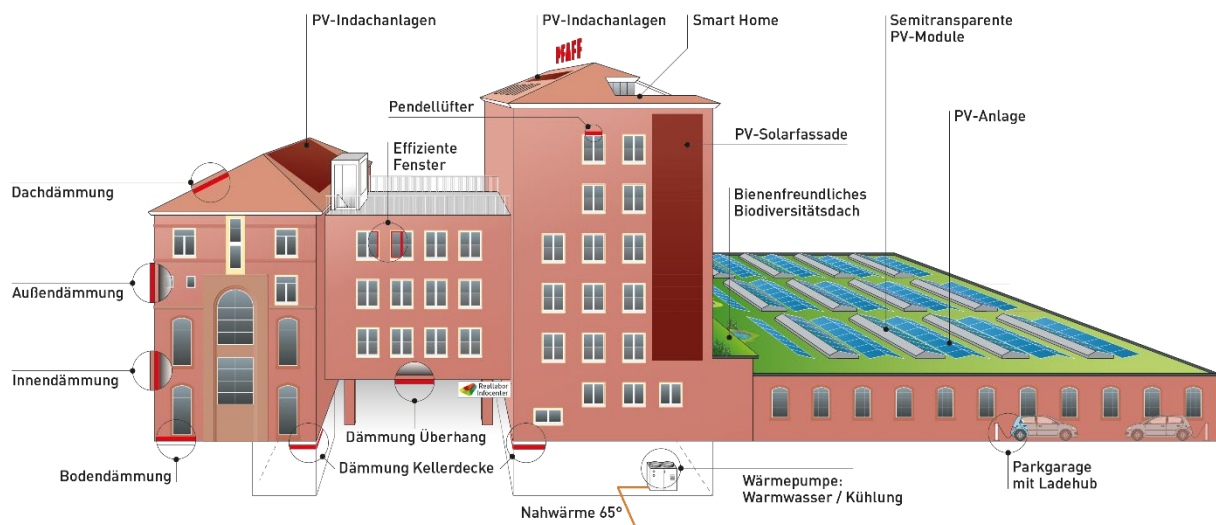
Verschiedene Installationsvarianten am Beispiel des Alten Verwaltungsgebäudes mit PV-Dach- und Fassadenanlage sowie PV-Gründach - © Triolog/EnStadt:Pfaff
